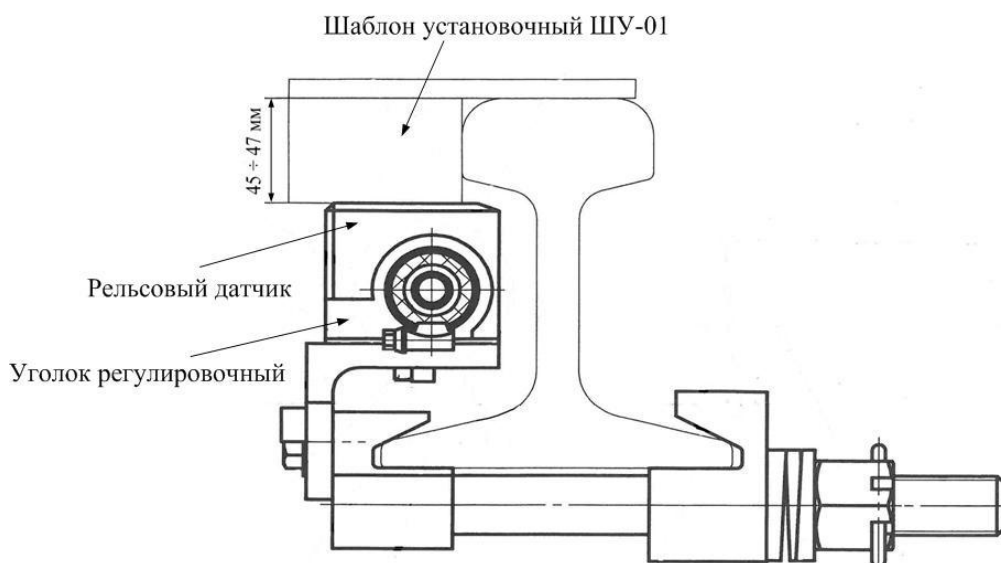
Наложение шаблона установочного ШУ-01 для проверки правильности крепления датчика ДПВ-02У к рельсу.
